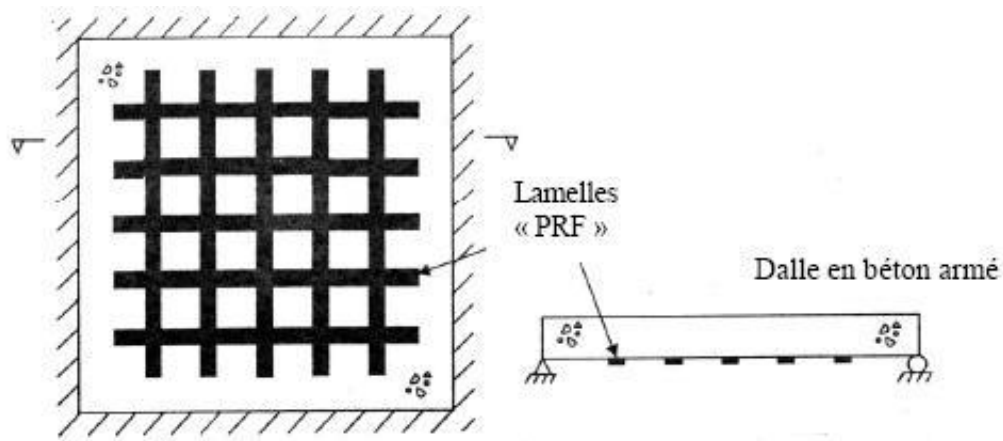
Renforcement d'une dalle (deux directions) [42].
